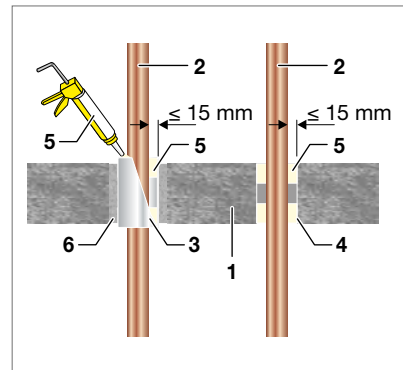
Viega Brandschutz Kitt – Abschottung mit Hüllrohr oder in Kernbohrung
